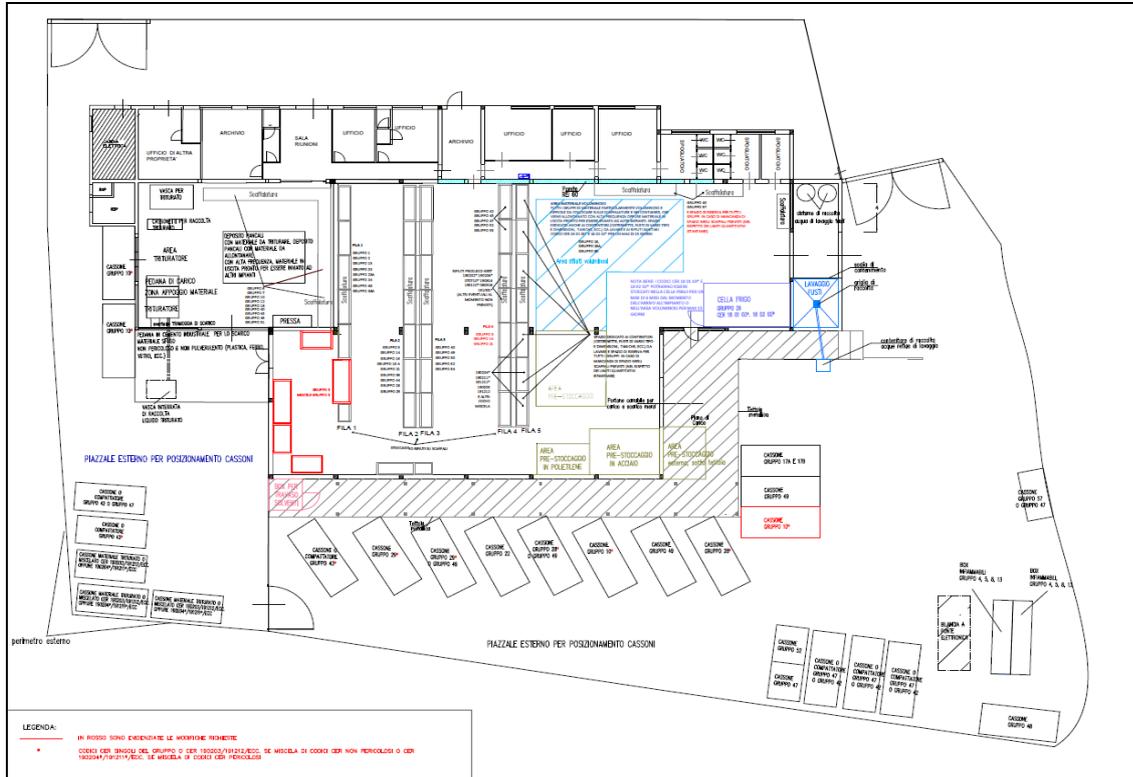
planimetria dell'impianto di messa in riserva e stoccaggio rifiuti Eco-Gest
